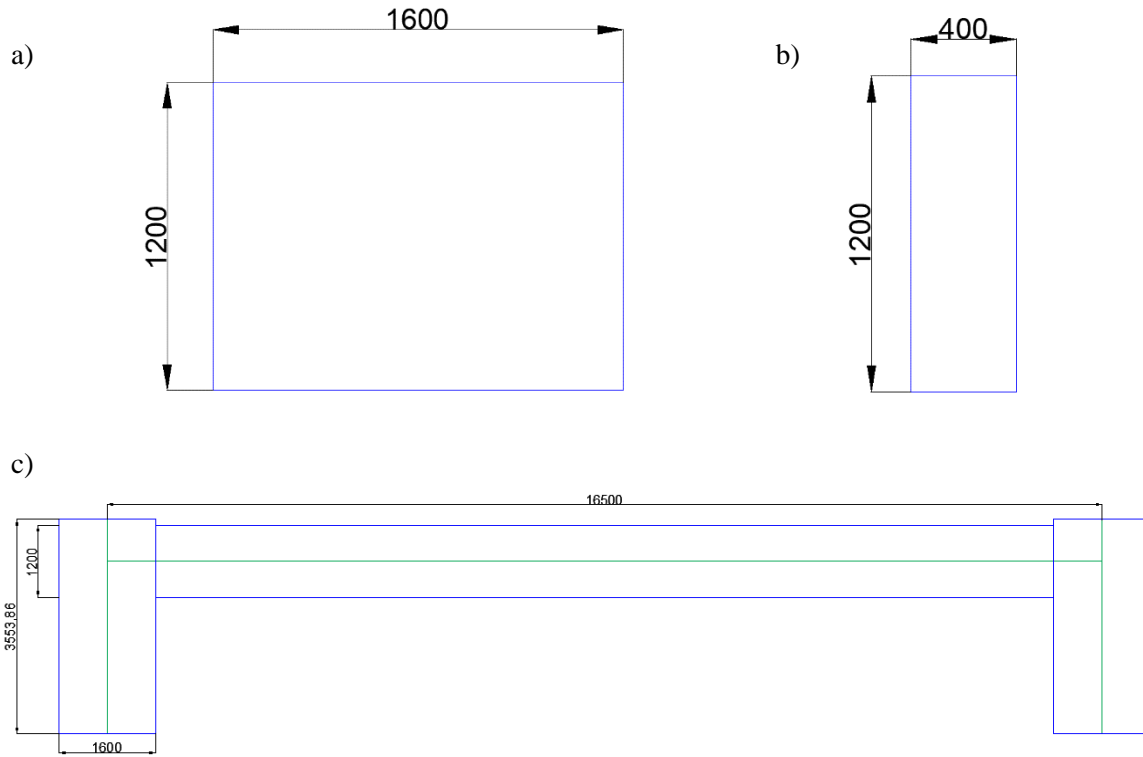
Secciones de las columnas y vigas: (a) Sección de la columna tipo; (b) Sección viga cabezal tipo y (c) marco de Concreto de 3.55 m de altura
